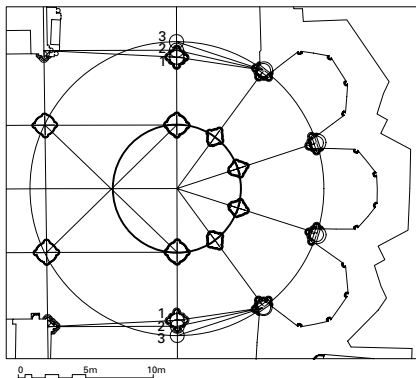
Planta del deambulatorio. Se han representado los trazados: 1, situación real actual del pilar de separación entre capillas y deambulatorio; 2, situación en la hipótesis de enfrentarlo con la pilastra de entrada a la nave lateral; 3, situación en la hipótesis de mantener constante la anchura del deambulatorio a costa de estrechar las capillas del transepto
